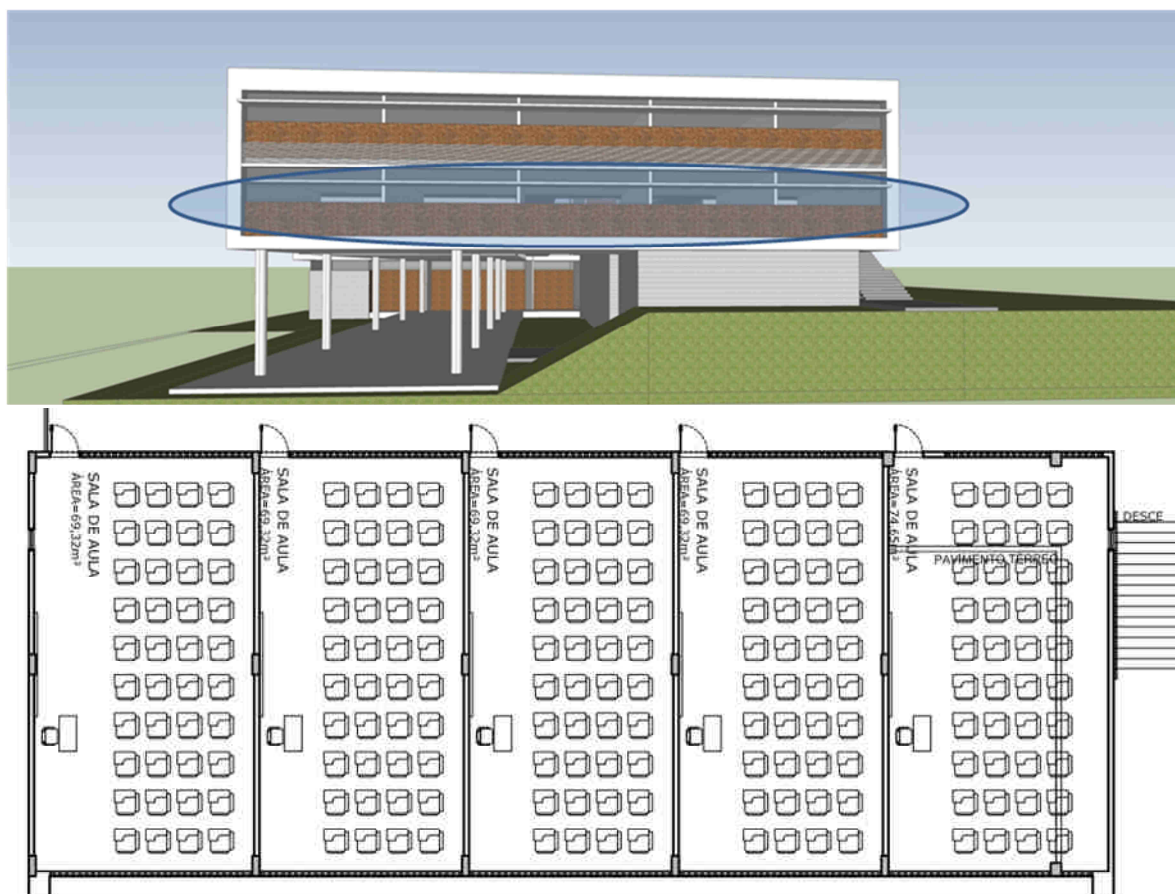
Salas de Aula - 1º Pavimento Bloco 01 – Fachada e Planta Baixa
